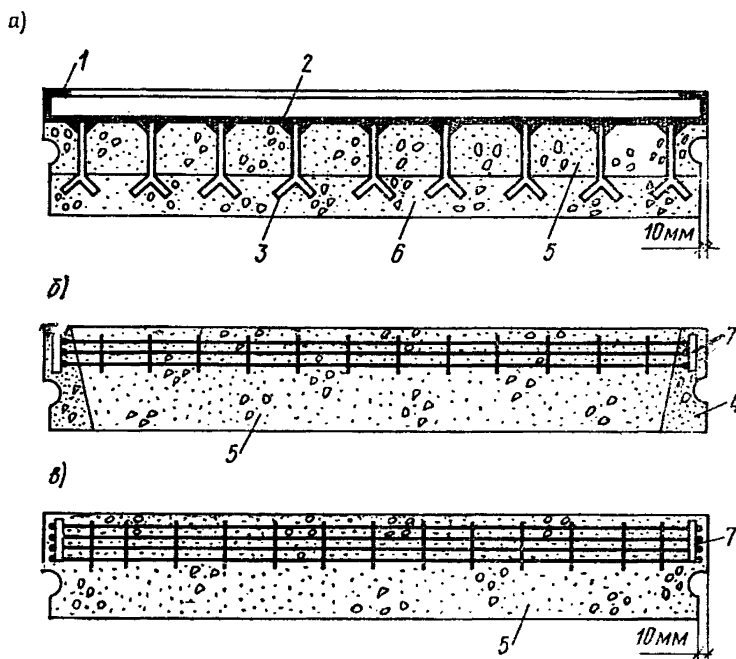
Конструкции панелей из легкого жаростойкого бетона
